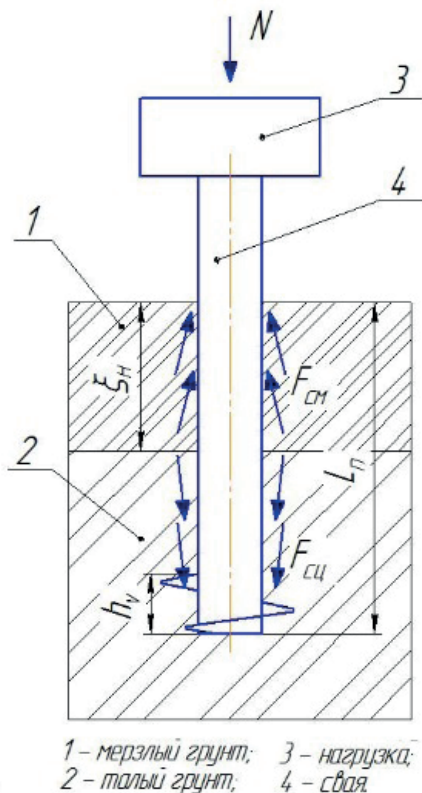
Винтовая свая с нагрузкой в промерзающем грунте
